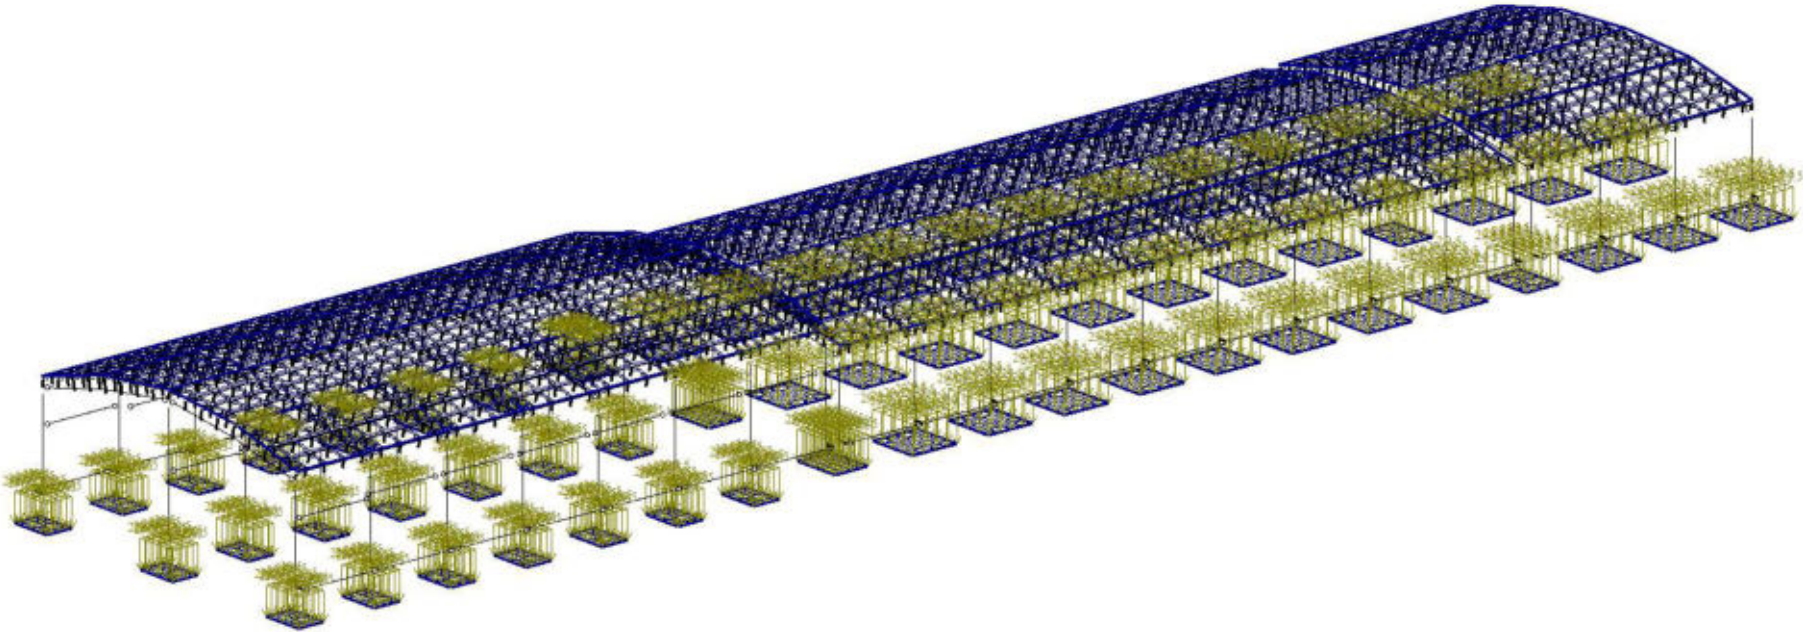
Расчетная схема с приложенной нагрузкой «полы и грунт»
